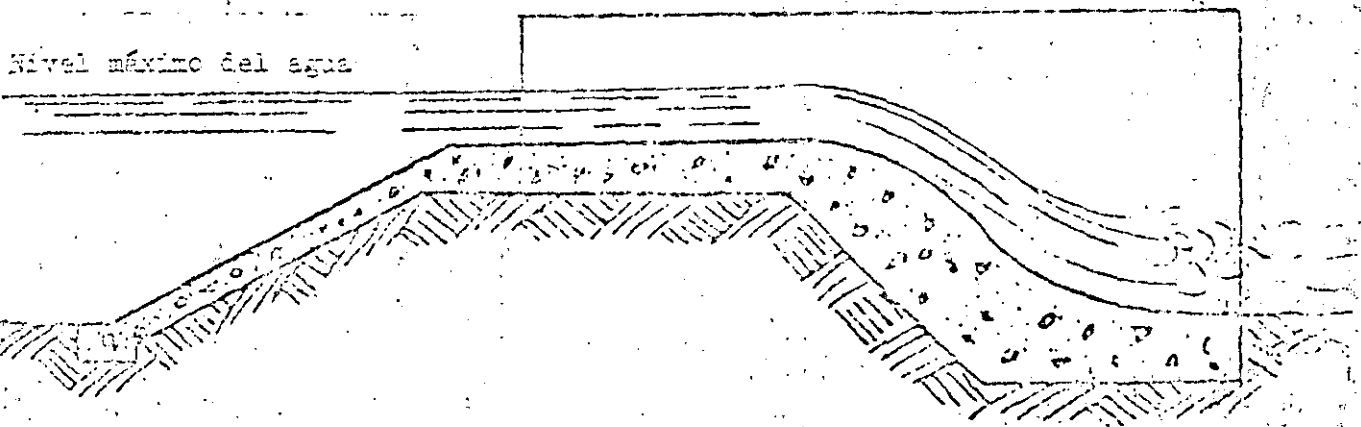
Rebosadero de concreto para una presa con relleno de tierra.
